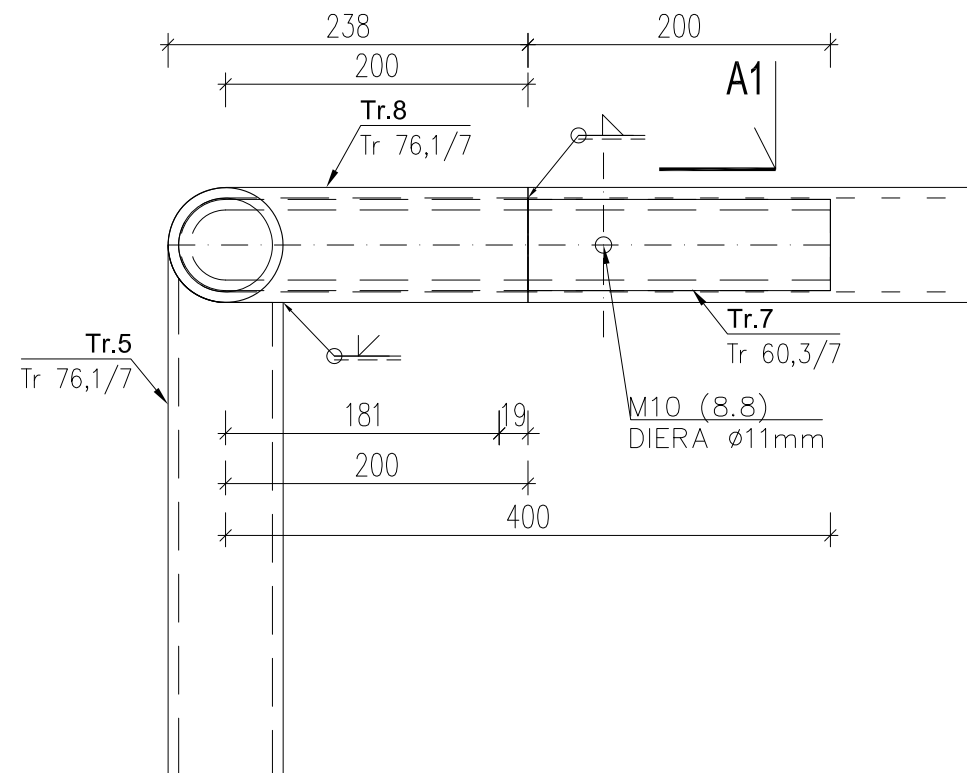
DETAIL "B" - REZOPOHĽAD B2; M 1:10
